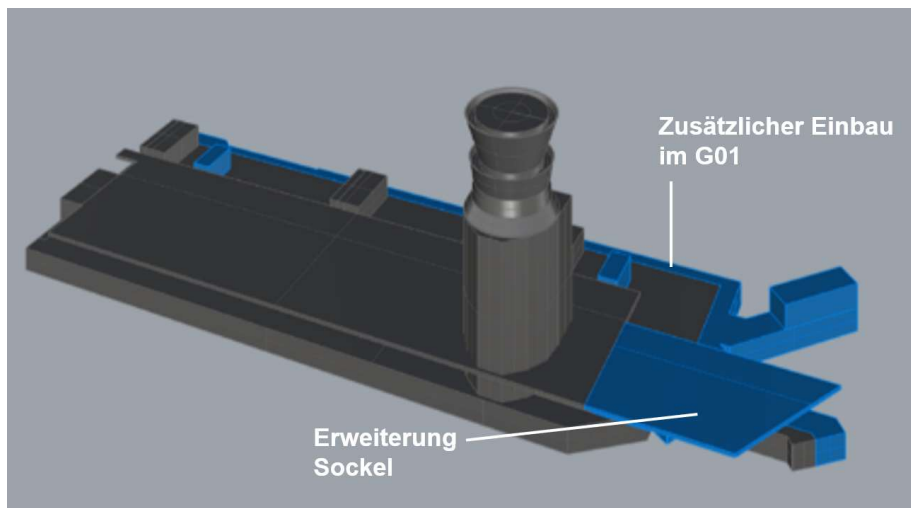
Projektänderungen ZRH Tower mit Umweltrelevanz
